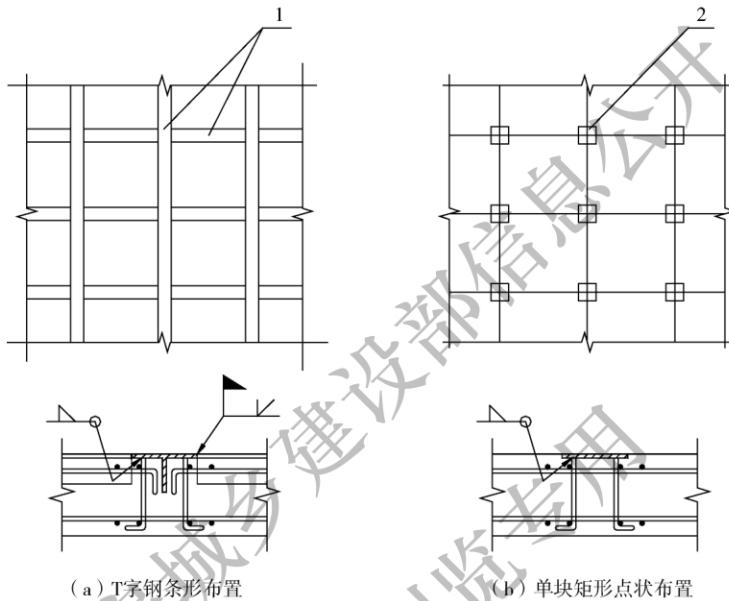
装焊地坪预埋件布置示意图
